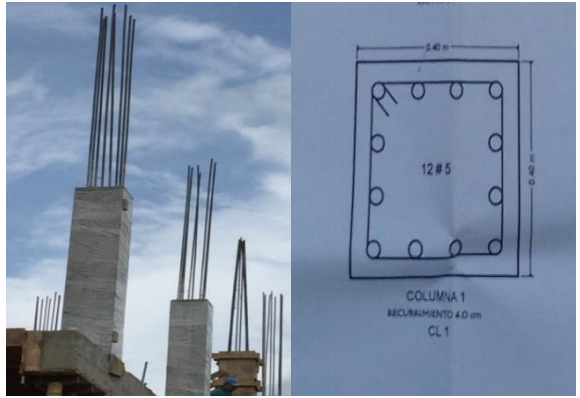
Alteración en las cuantías de acero de las columnas, fuente propia
